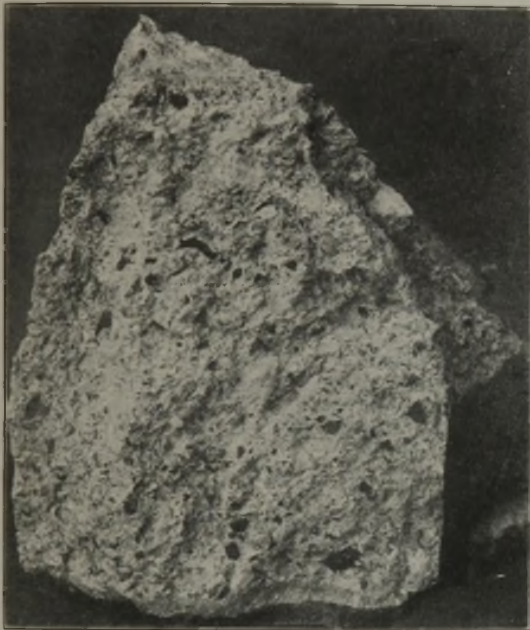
Auf Wasserundurchlässigkeit untersuchtes Betonstück.
